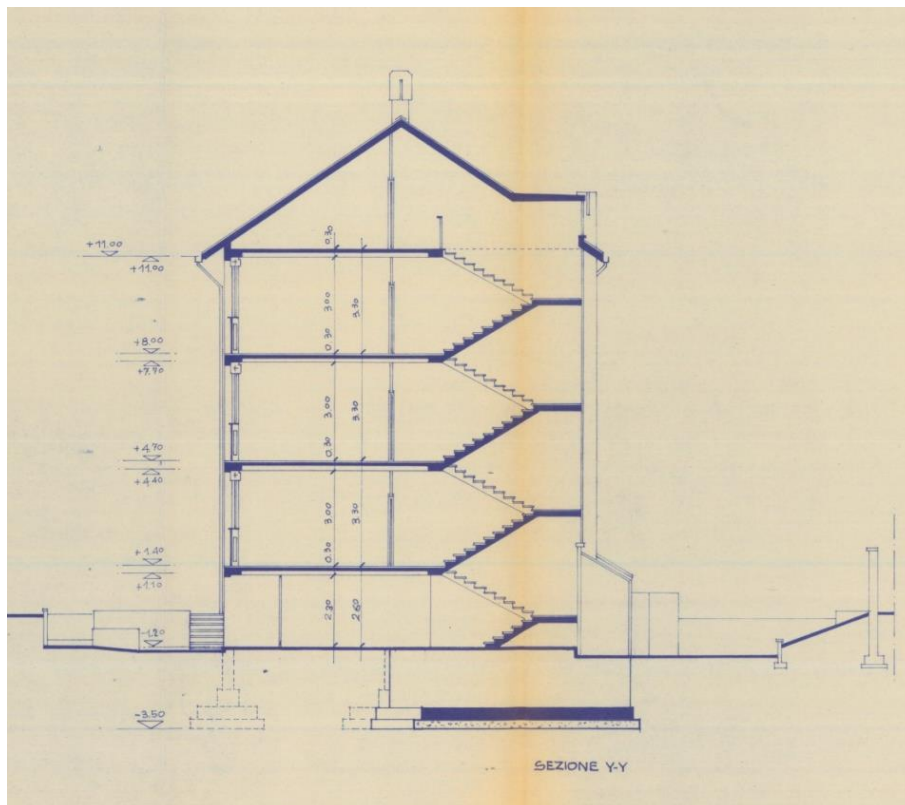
, Sezione Y-Y'; scansione progetto originale
